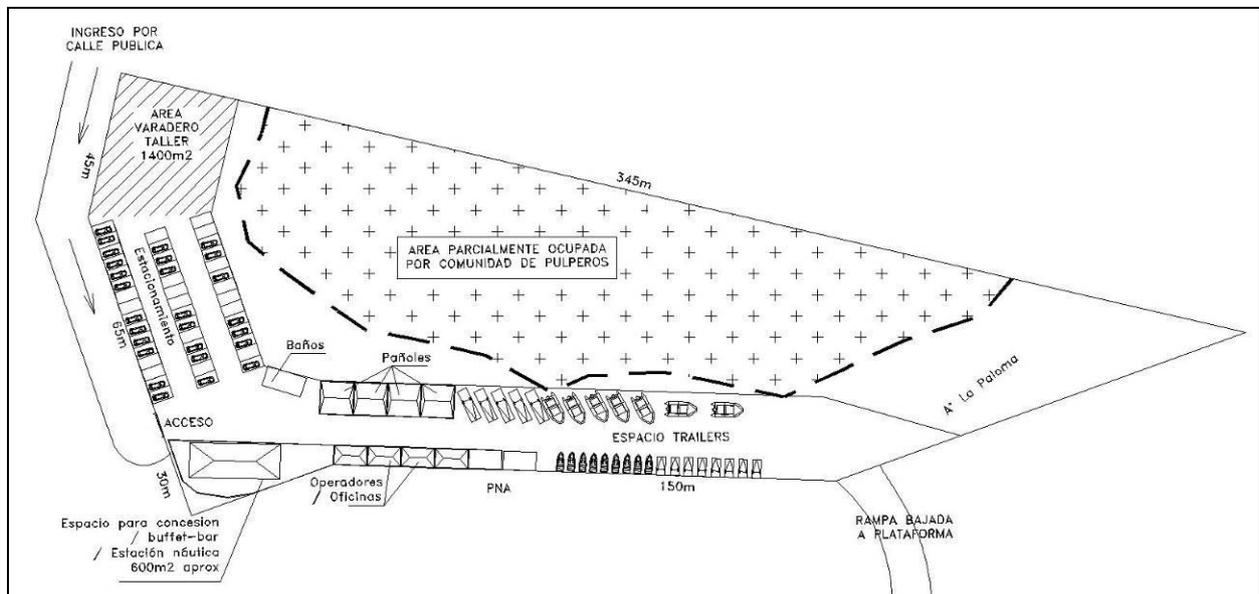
Extracto de plano, layout de infraestructura terrestre. Fuente: elaboración propia
